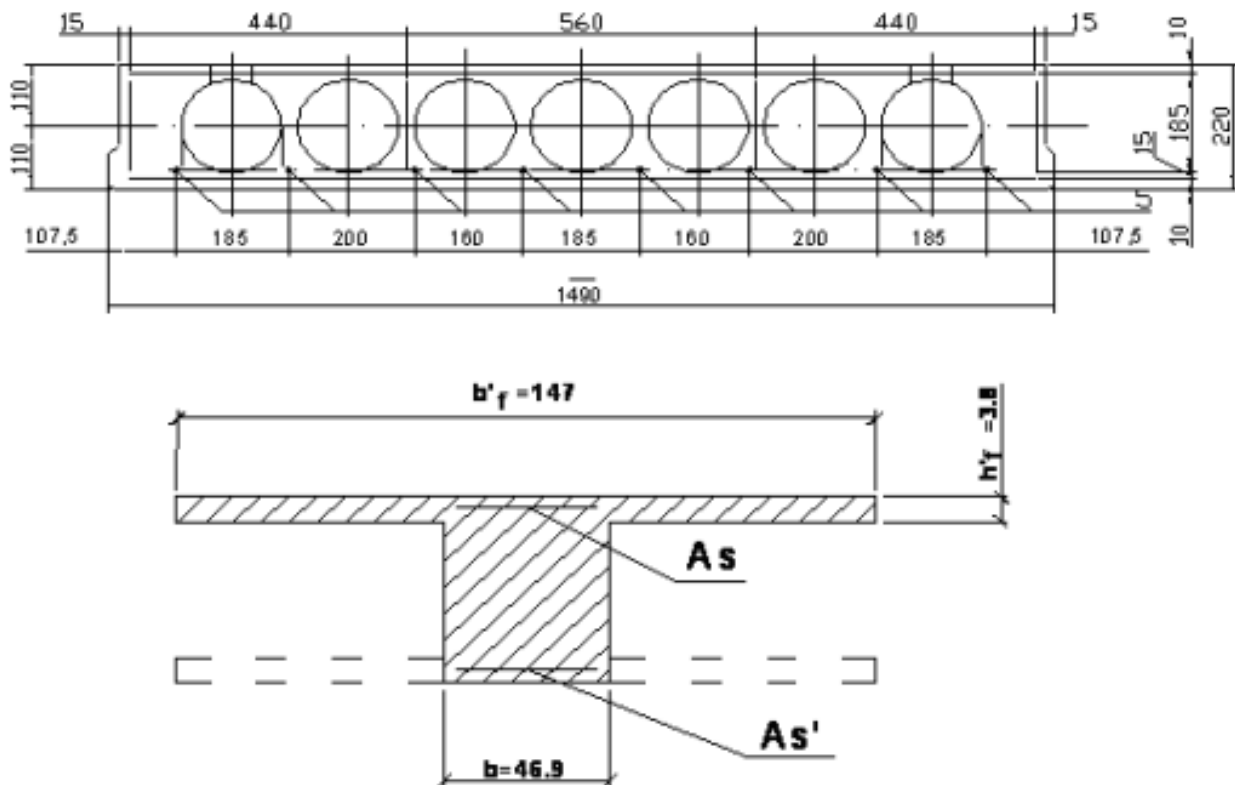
Схема армування багатопустотної плити перекриття
